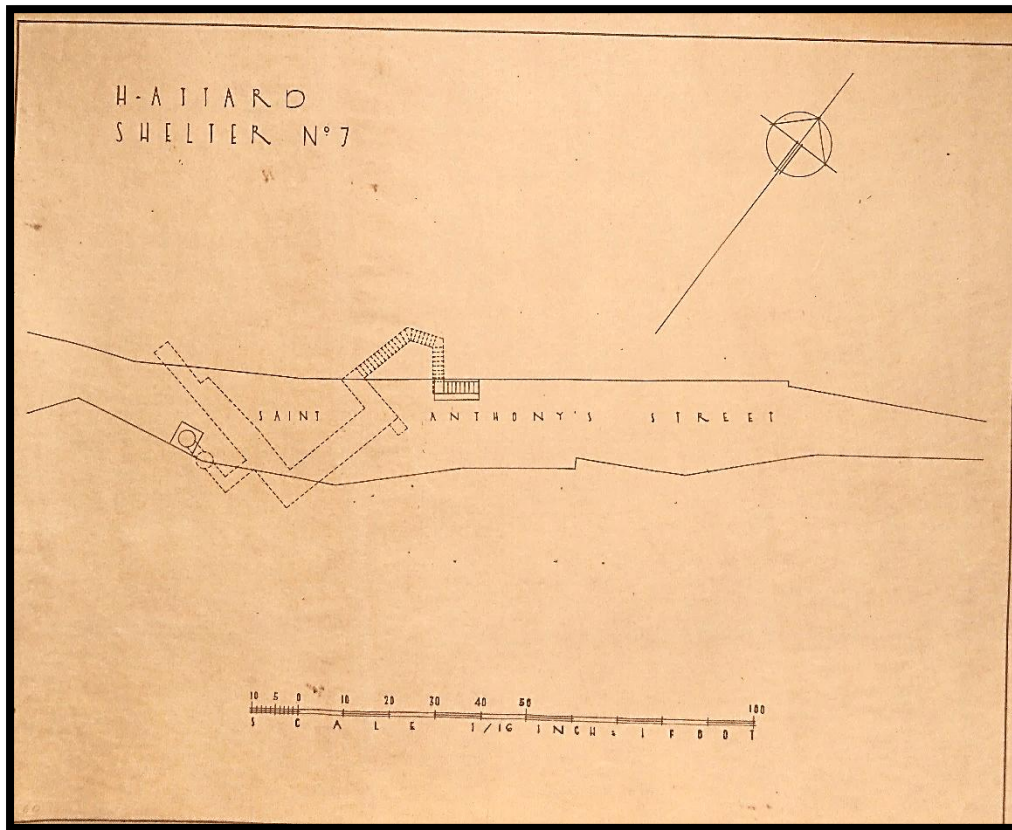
Planta do Abrigo nº7 "Saint Anthony's Street"
